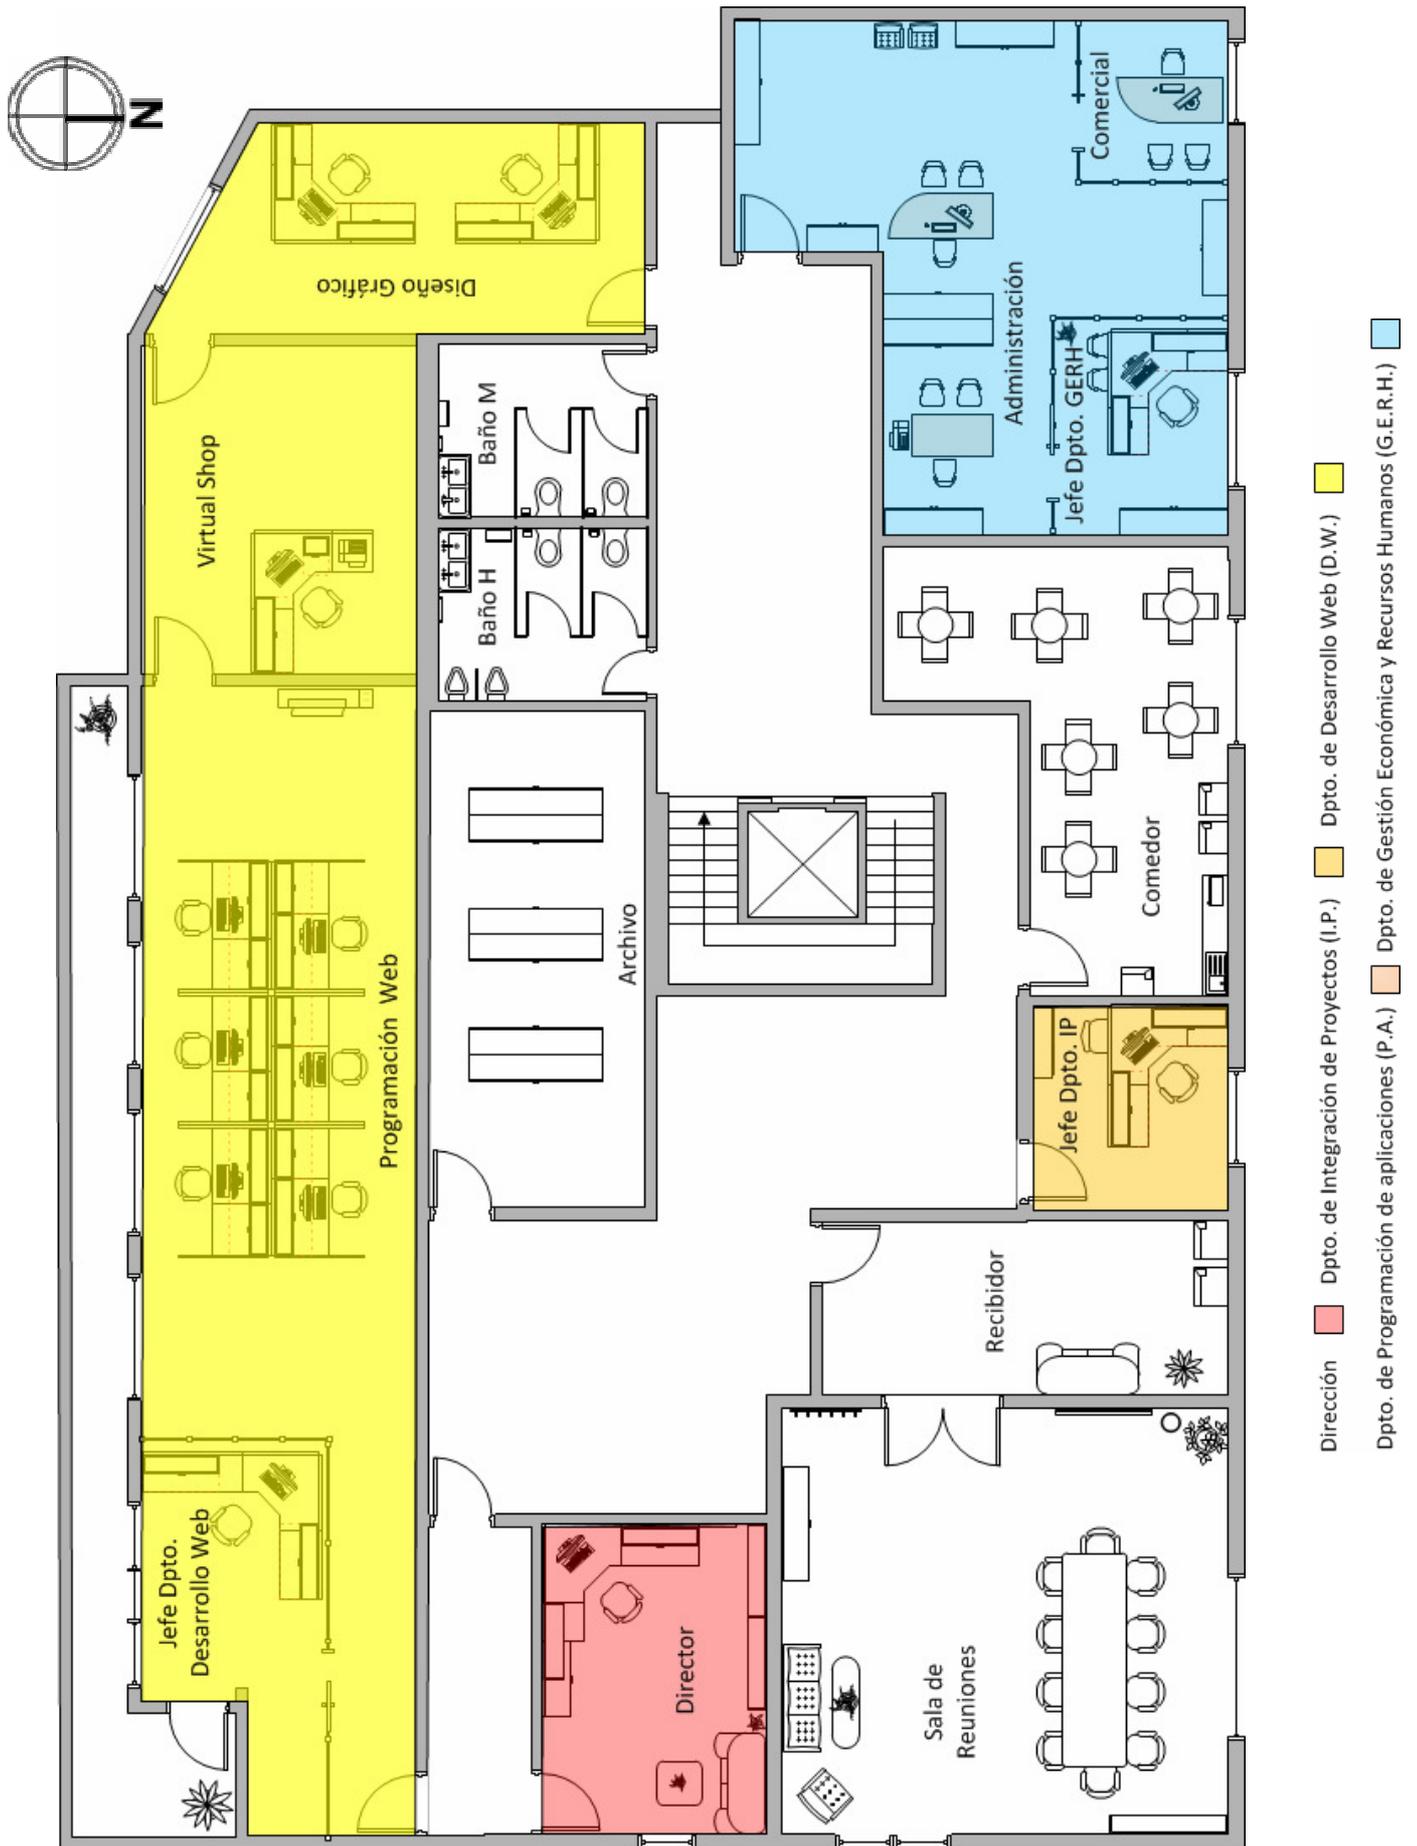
Distribución de las instalaciones de la 1ª Planta
